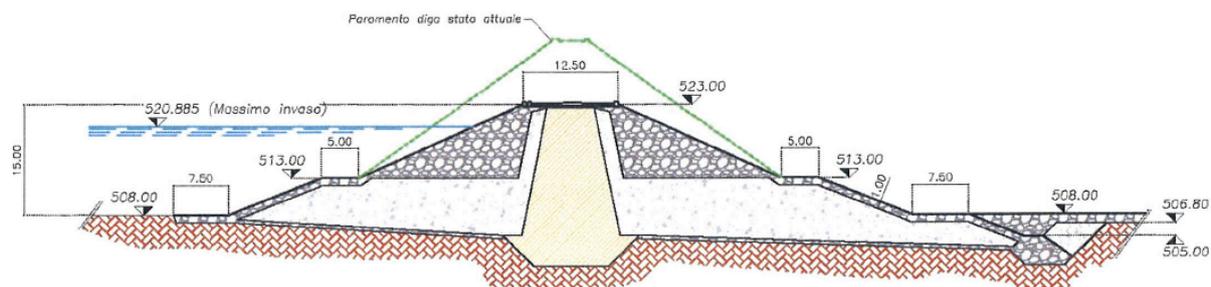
Sezione dello stato di progetto della diga di Acciano. Tratte dal progetto preliminare di declassamento elaborato da ATI n° 3 e Regione Umbria.
